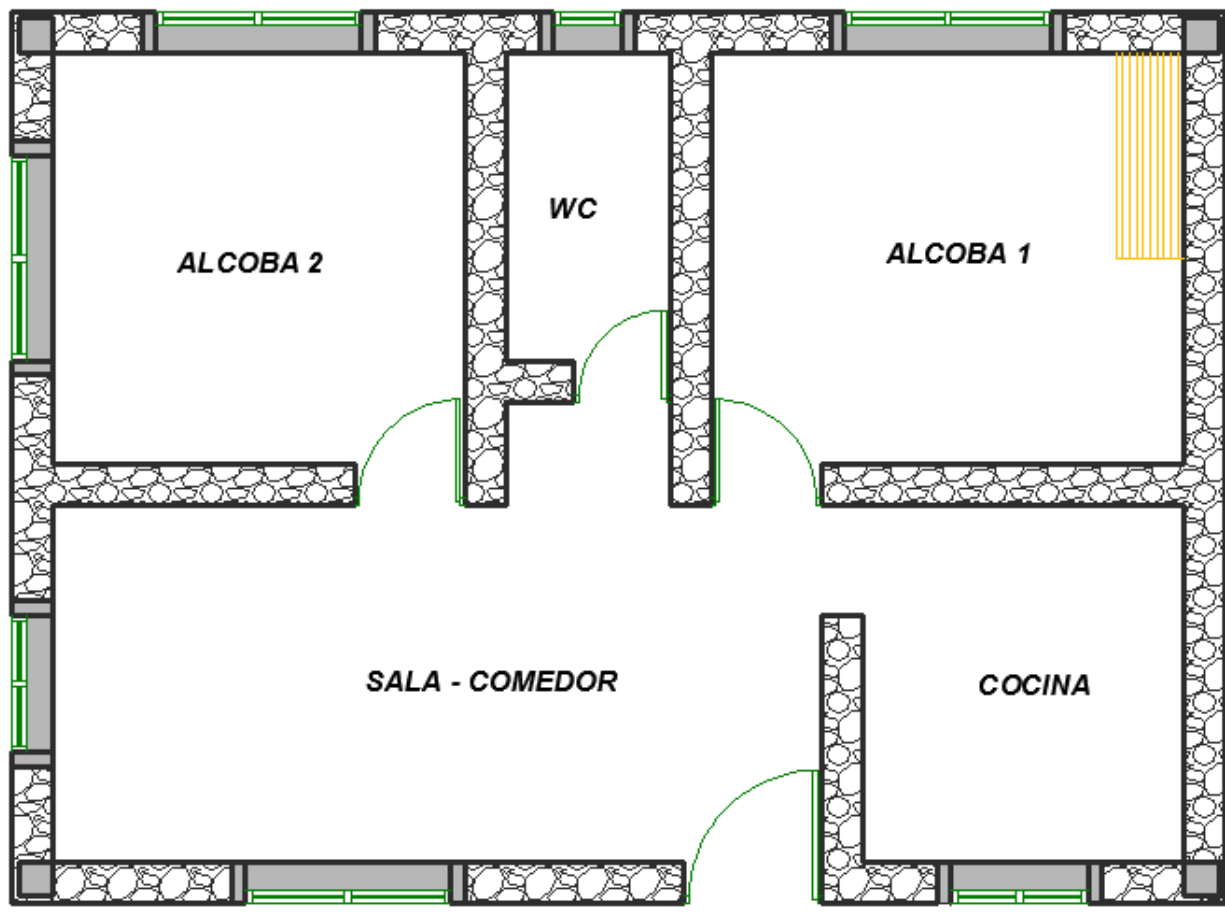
Planta general. Diseño arquitectónico vivienda sostenible. Fuente: Propia.
